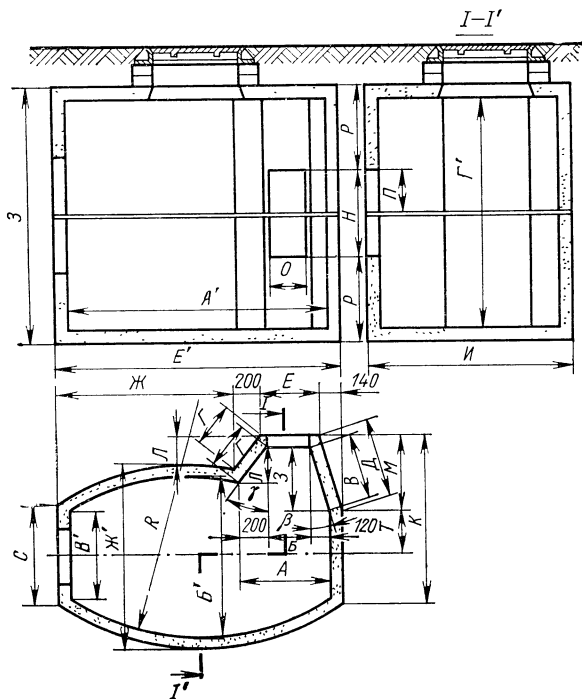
Конструкция специально угловых сборных и монолитных железобетонных колодцев типов ККС-3, ККС-4 и ККС-5 овальной формы
